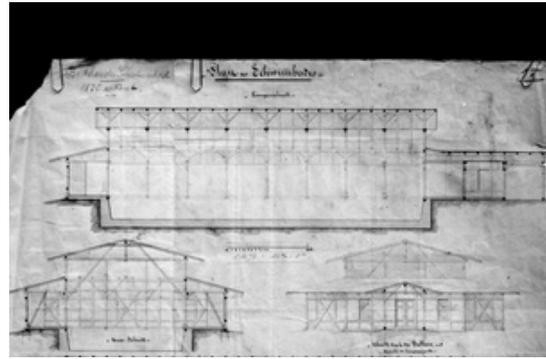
Bad Ragaz, Plan 35, Hallenbad, Längs- und Querschnitt, 1870
